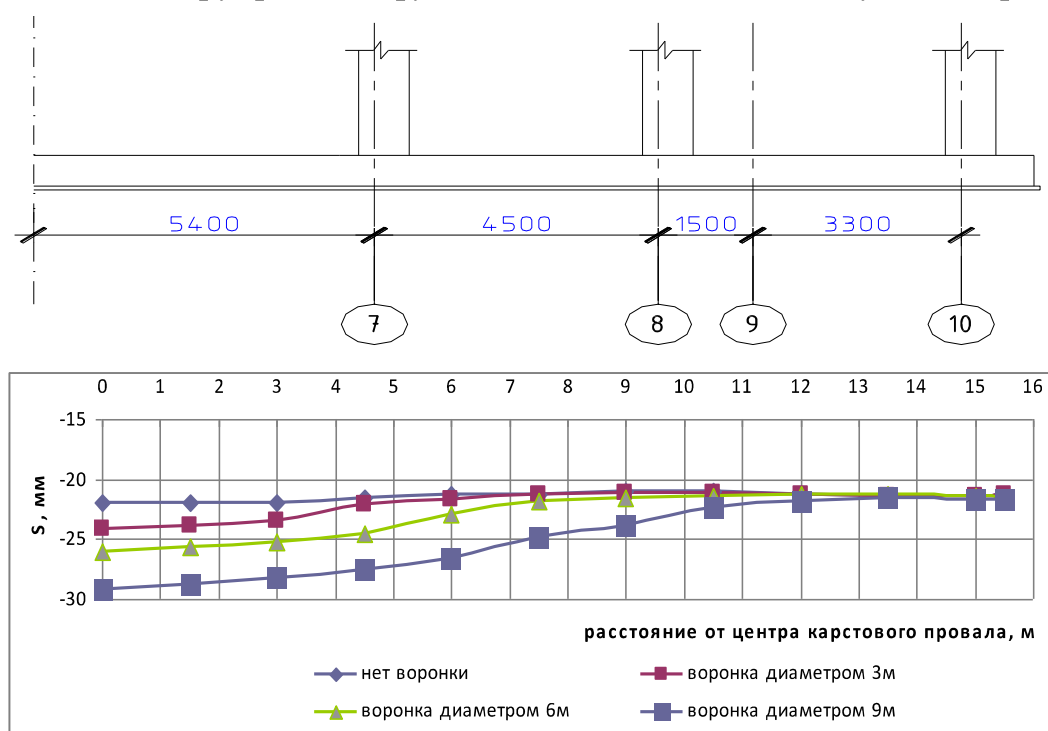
Осадки основания под фундаментной плитой здания с учетом образования карстовой воронки
